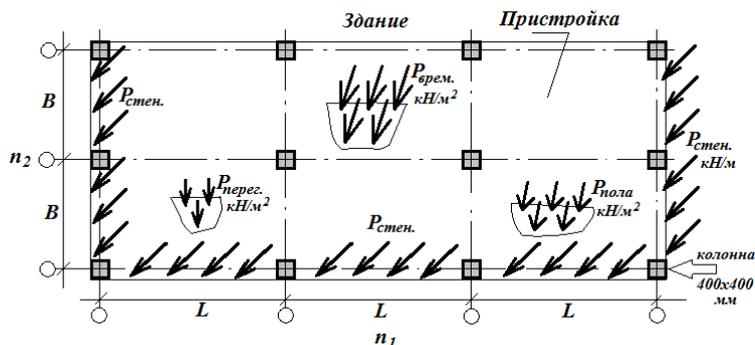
Размеры плиты перекрытия в плане и схема приложения нагрузок.
